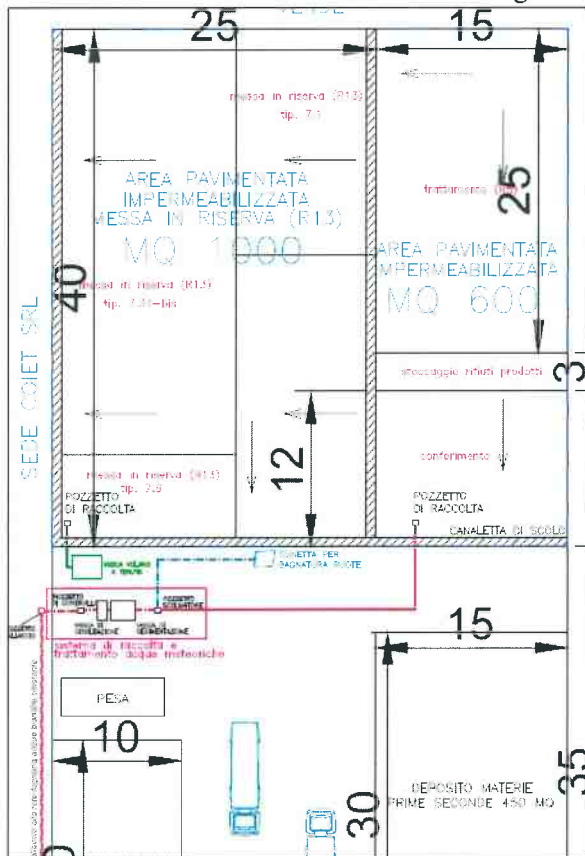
Planimetria dettaglio reti idriche (da Tav. 15 allegata allo SPA)
